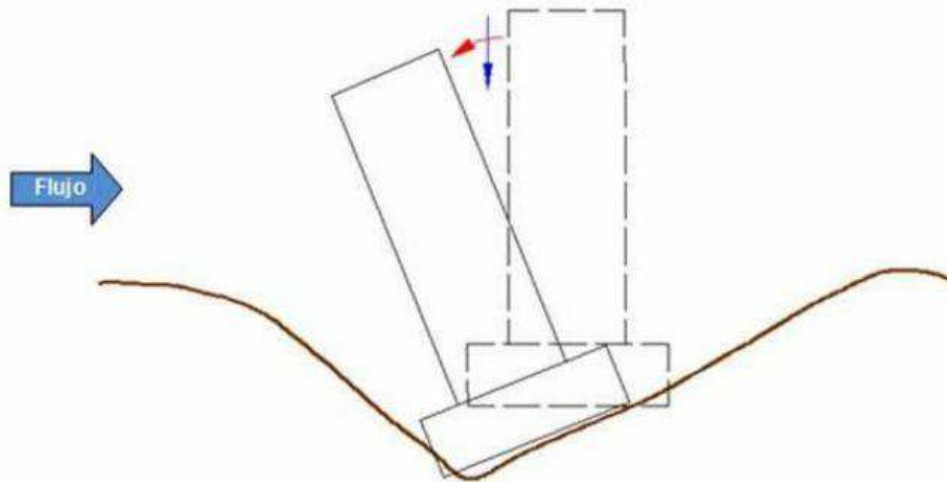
Falla típica de un pilar por erosión local (Martín-Vide).
